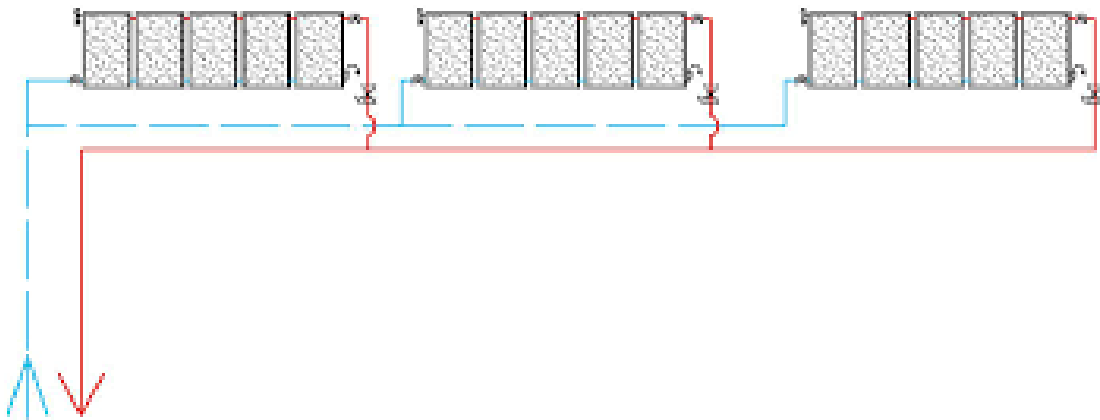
Conexionado en serie-paralelo.
